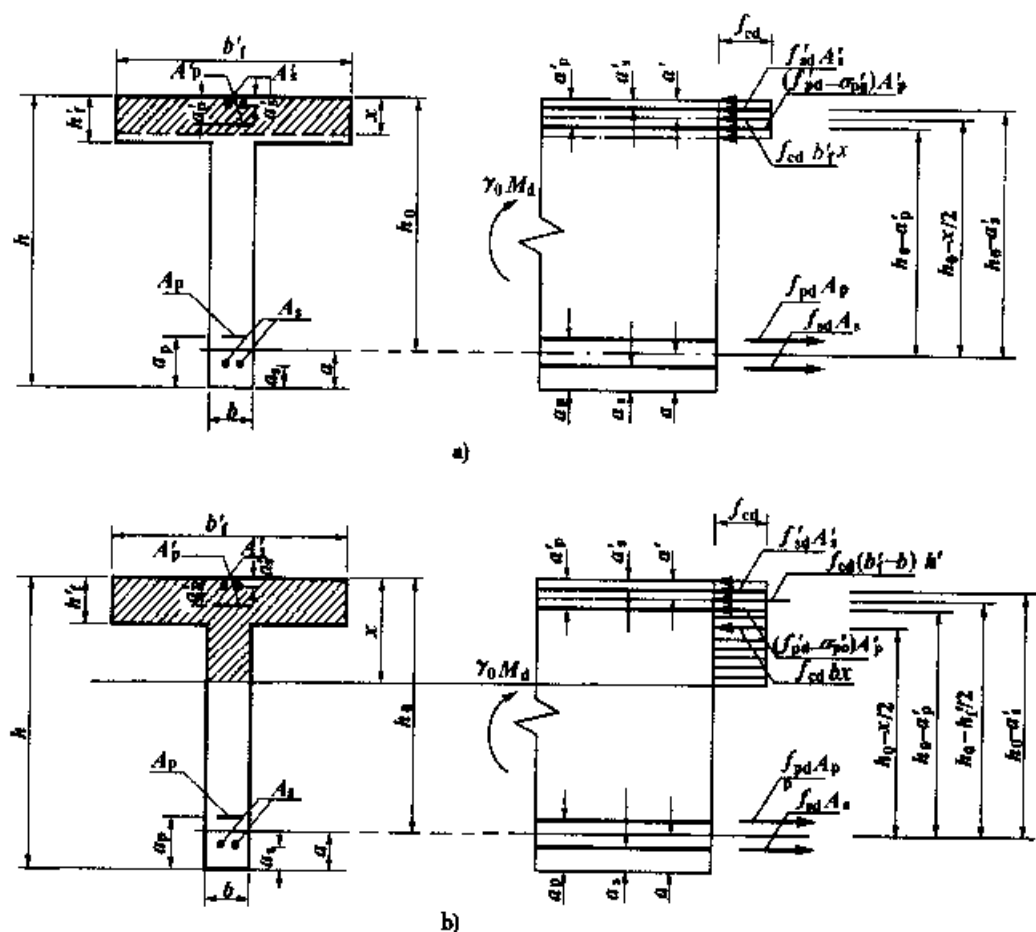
预应力混凝土 T 形截面受弯构件正截面承载力计算图式
